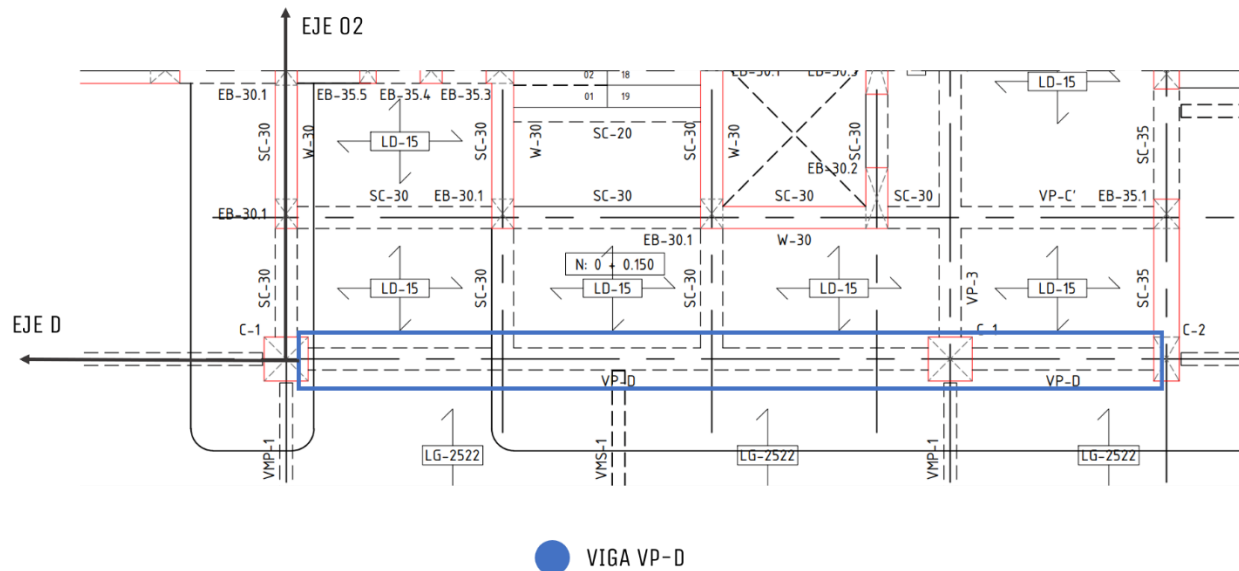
Detalle de ubicación de tramo de viga VP-D a colar.
